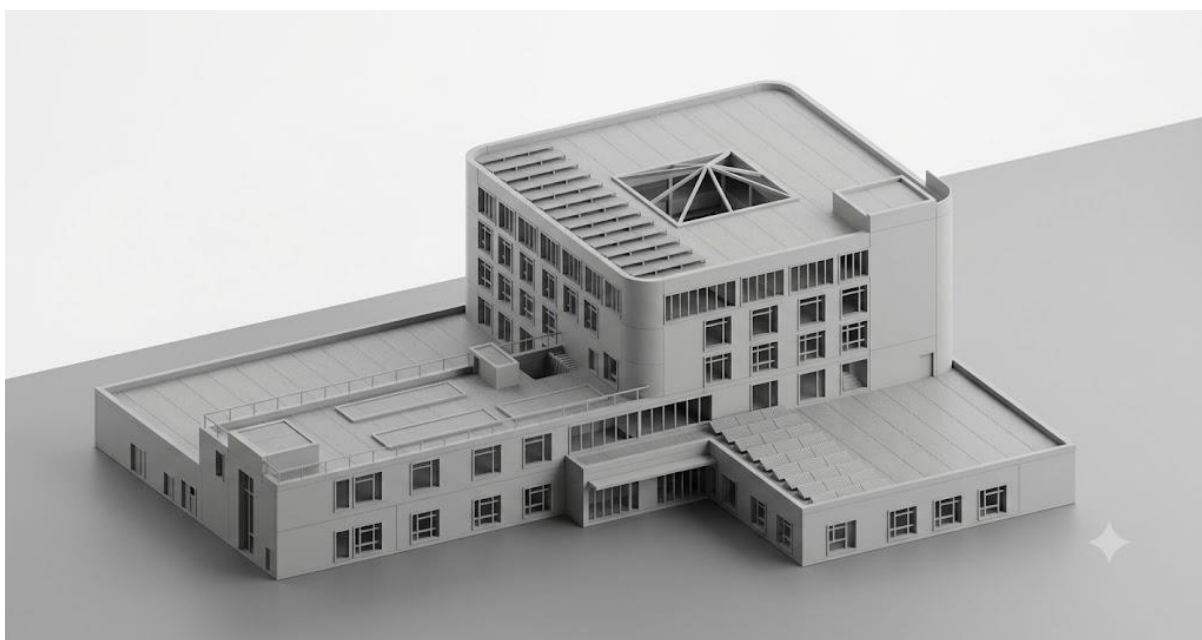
Просторово-композиційні пошуки форми реабілітаційного центру
